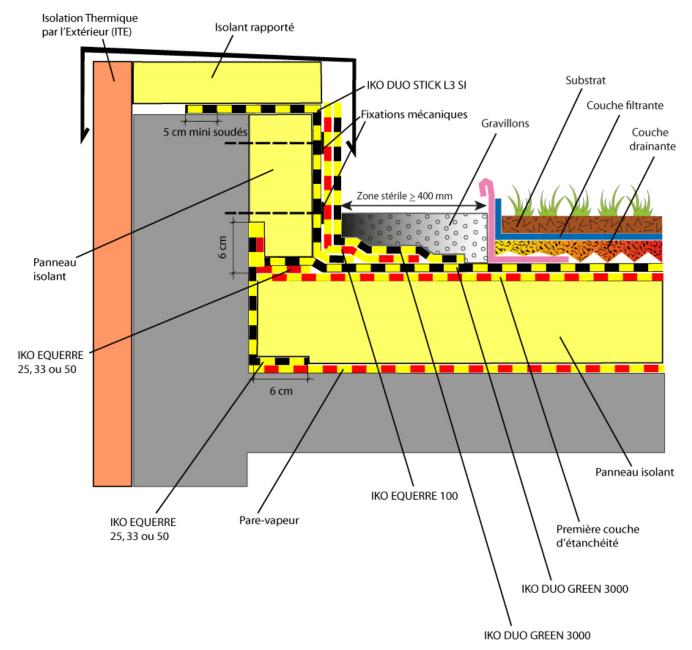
is : Relevé sur isolant thermique PUR ou PIR suivant DTA apte à recevoir un revêtement autoadhésif des toitures et terrasses végétalisées sur éléments porteurs en maçonnerie – variante (Cf. DTA isolant et revêtement d'étanchéité)
